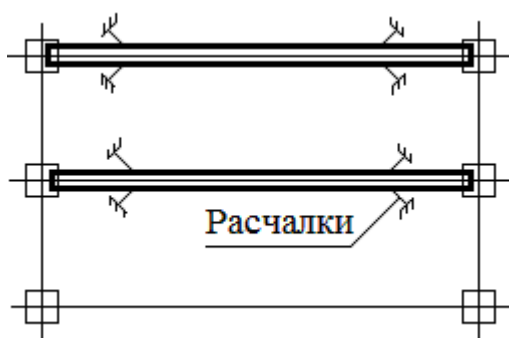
Схема временного крепления двух первых монтируемых ферм
